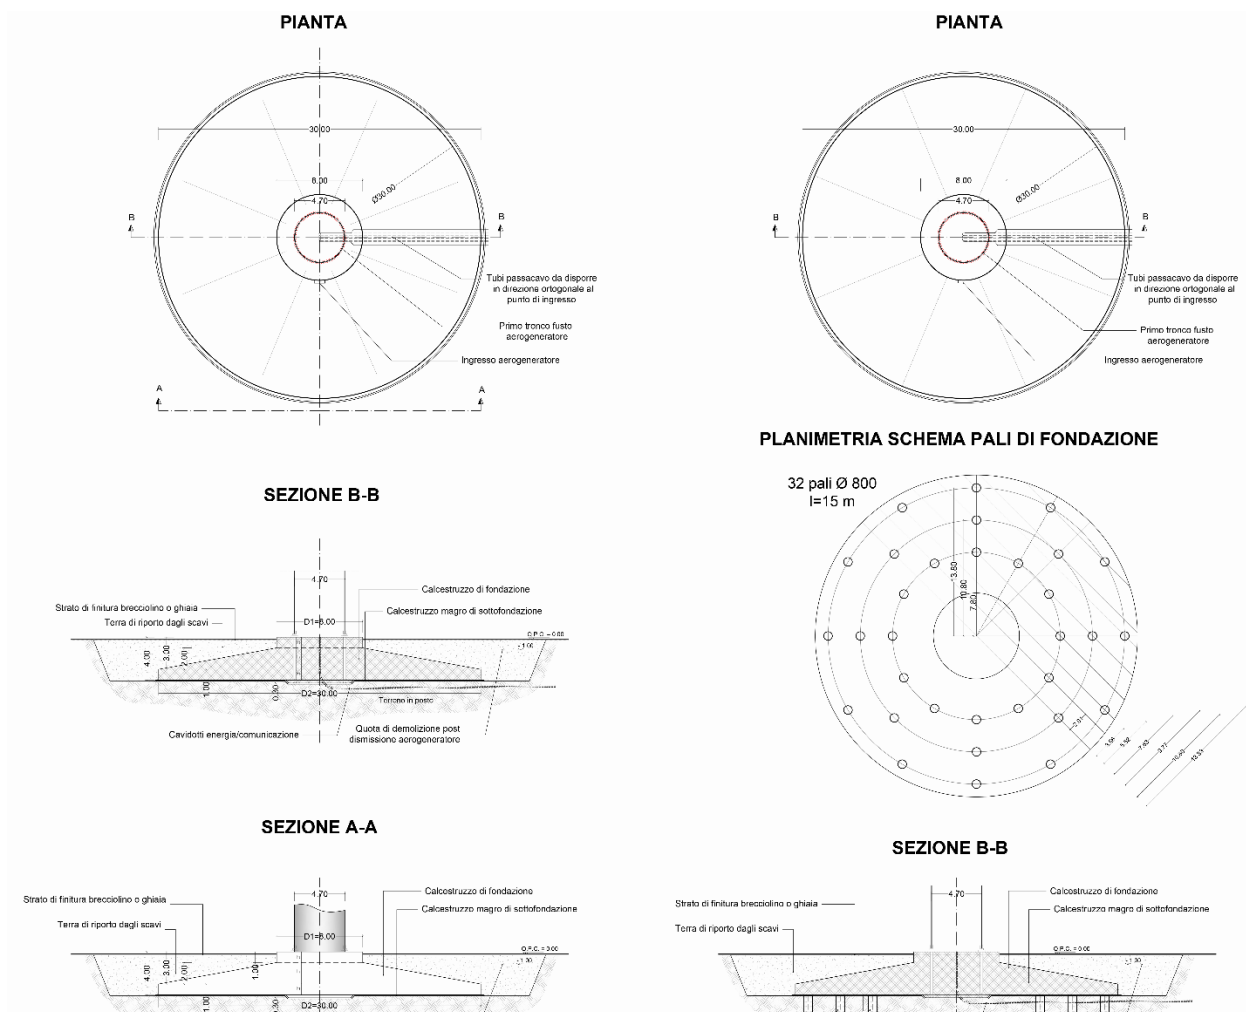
Pianta e vista della fondazione tipo dell'aerogeneratore
